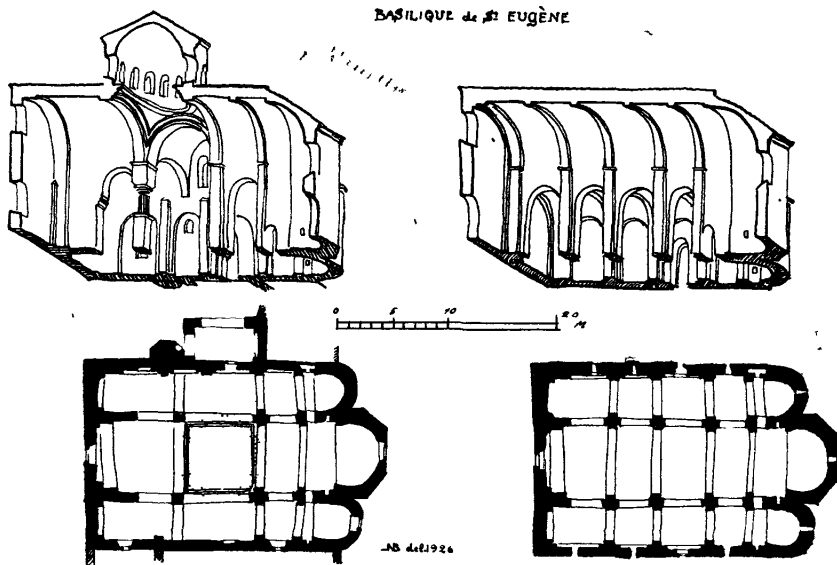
Plan et coupe de Saint-Eugène : état actuel, état primitif (restitué).
